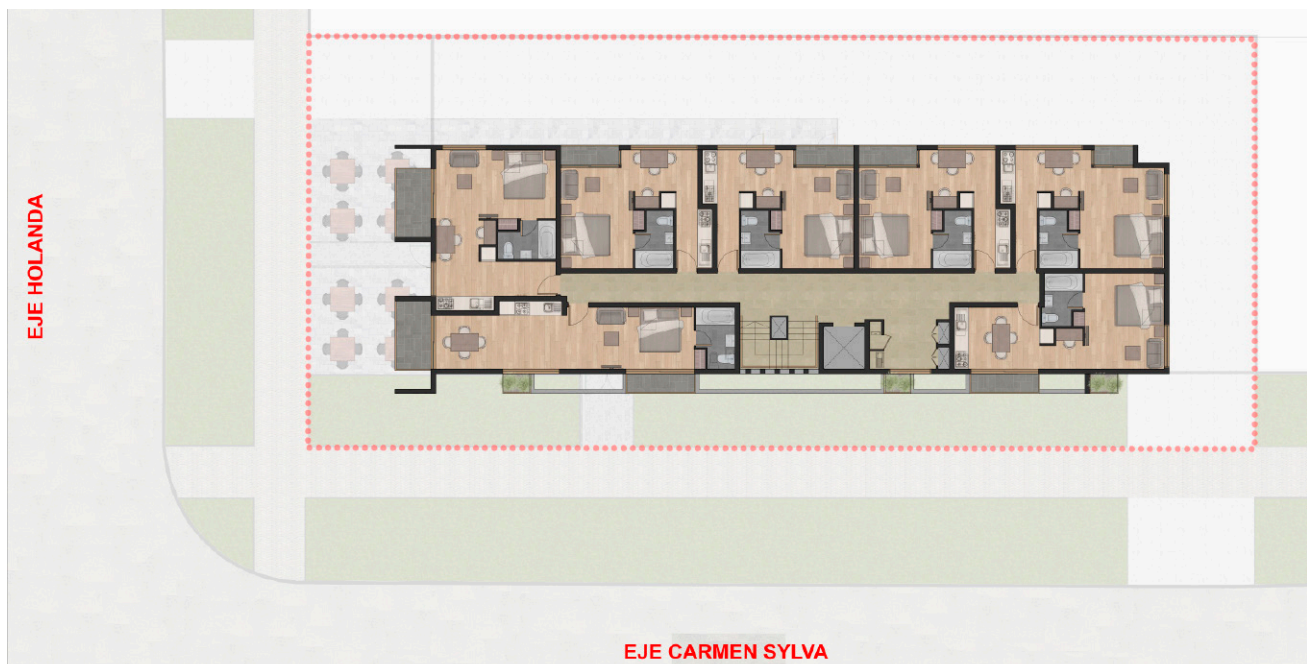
Planta de arquitectura piso tipo 1 al 5. Escala 1:1000. Fuente: El autor (2019).
